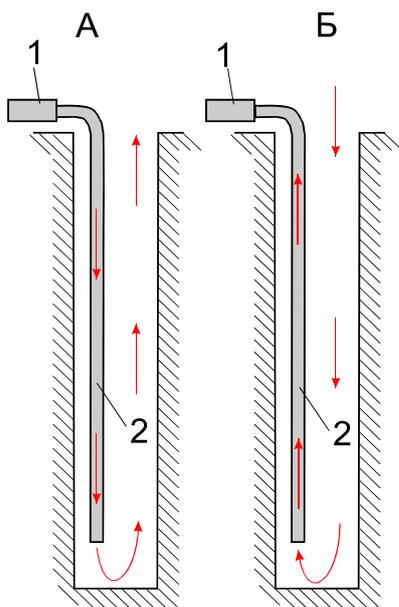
Схема вентиляции шурфа: а – нагнетательная; б – всасывающая; 1 – основной вентилятор; 2 – воздуховод (вентиляционная труба)
